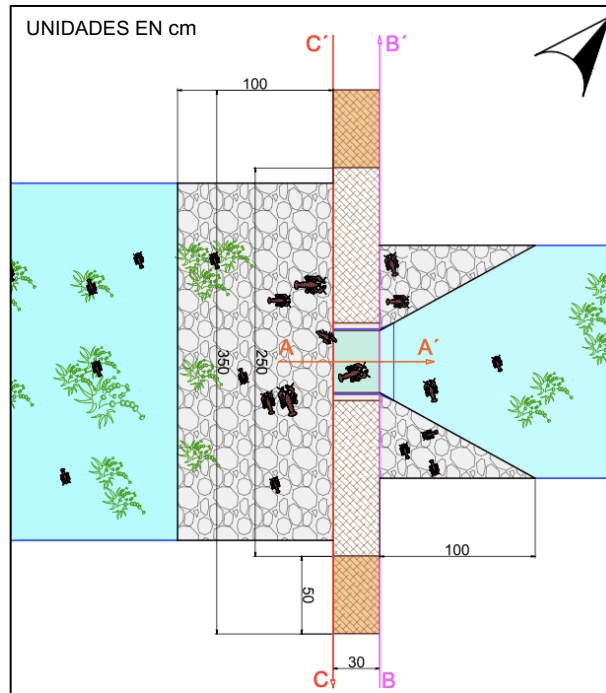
Planta general del plano del refugio de pozas formado por dos troncos de álamo y piedras calizas.
